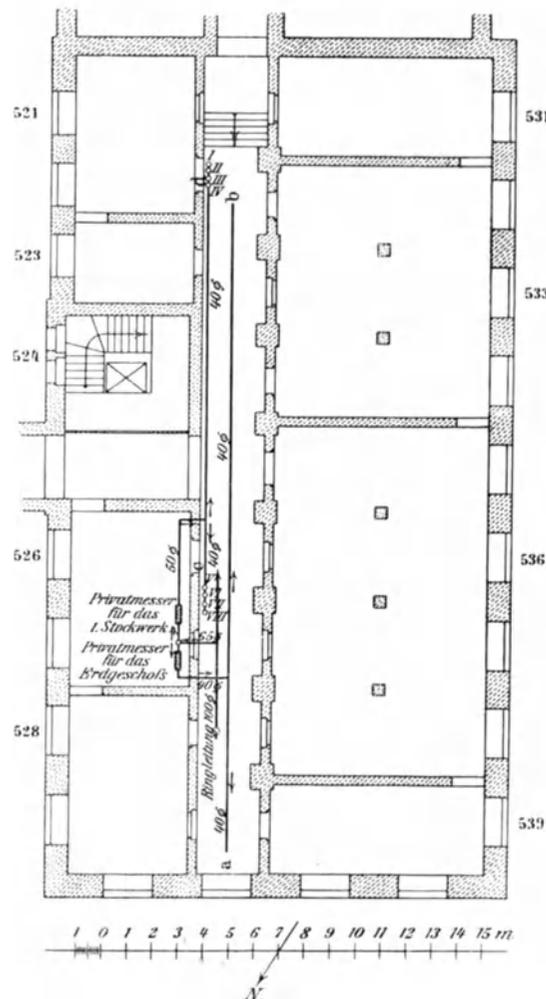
Betriebswasserleitung im Kellergeschoß des westlichen Laborgebäudes mit den Abzweigen nach dem Erdgeschoß und I. Stockwerk.
